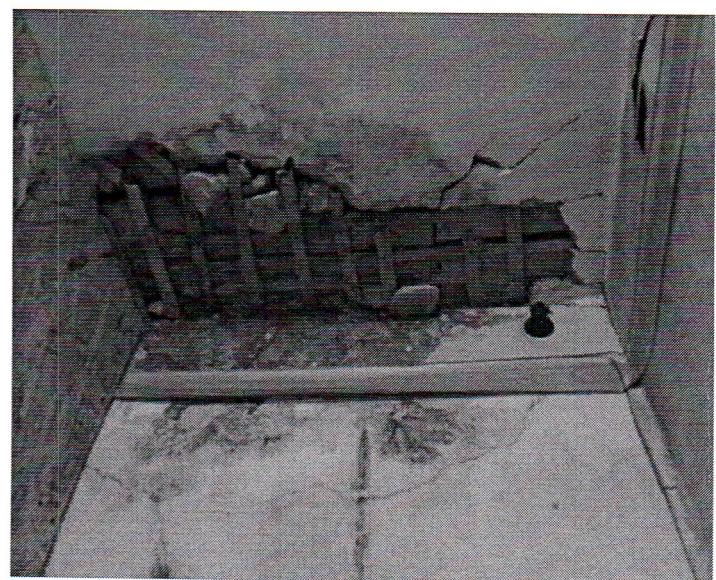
Фрагмент фото 26. Отпадение штукатурки на потолке санузла.
